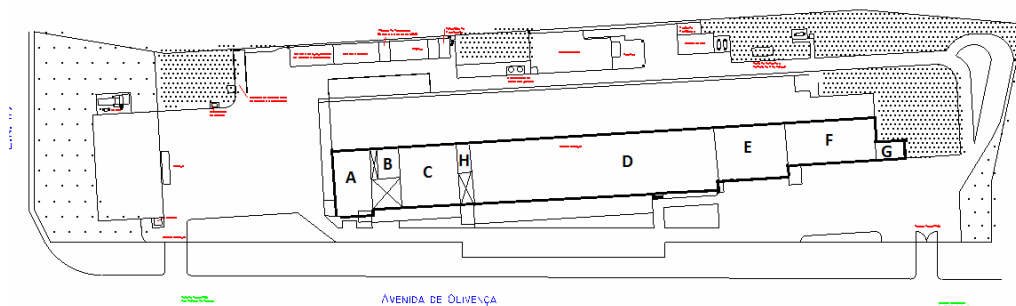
Planta da unidade Montijo-Montalva dividida em 8 sub-áreas úteis para instalação
